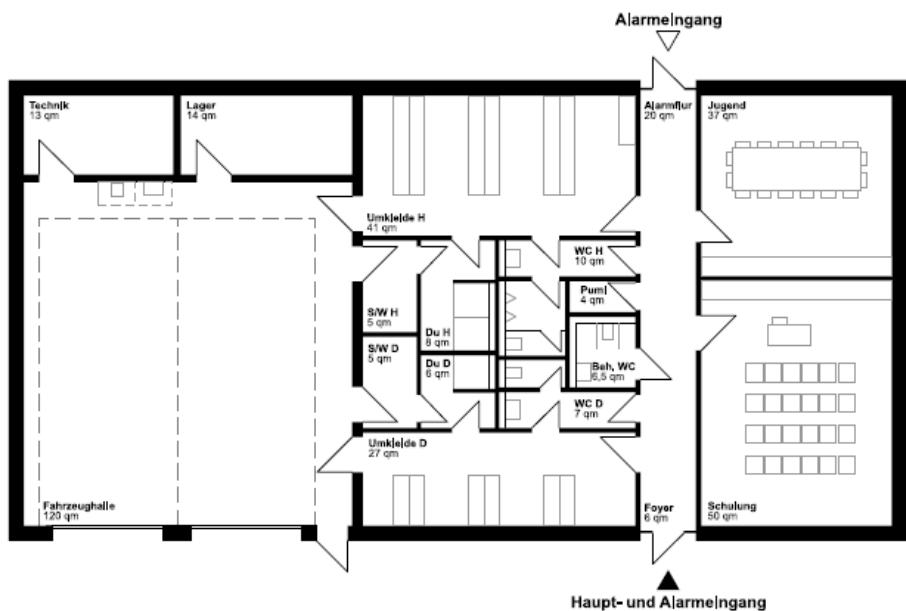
Grundrissplan, flächenbereinigt
